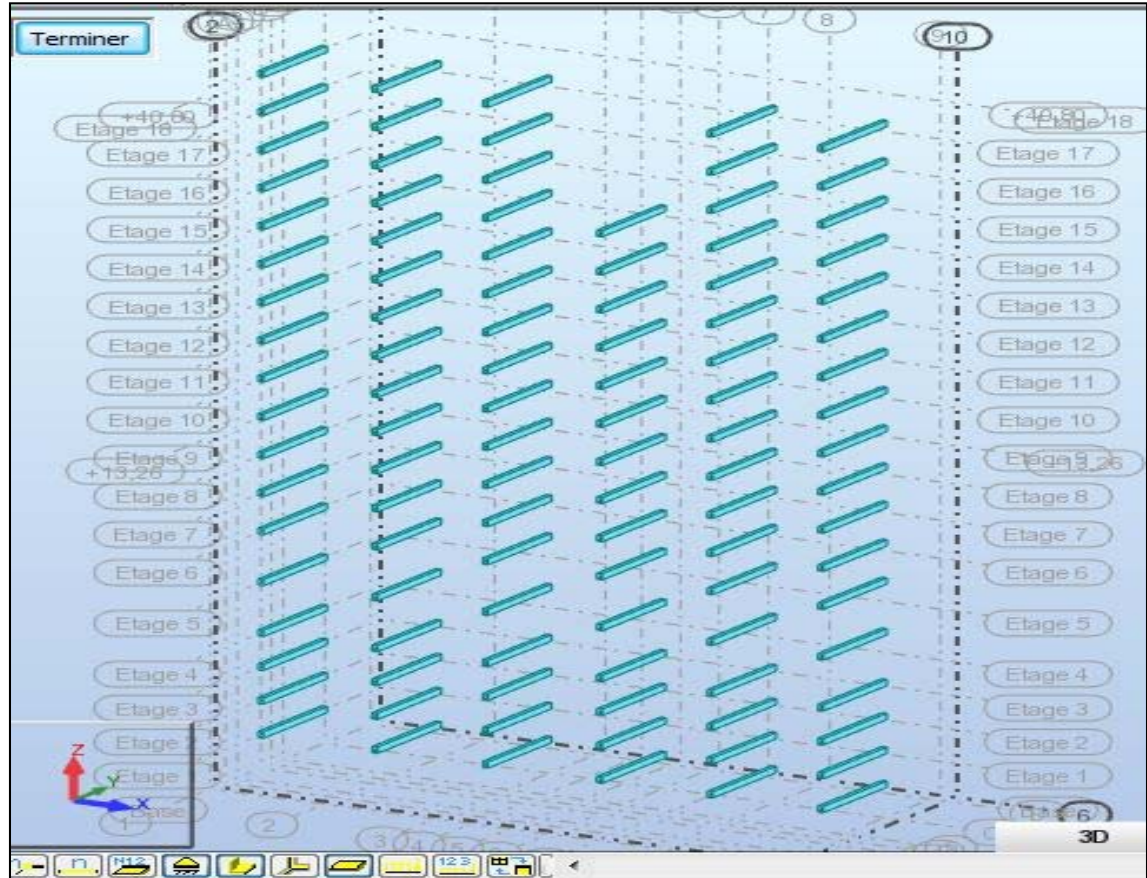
Vue En 3d Poutres Secondaire De La Structures (30x50)
